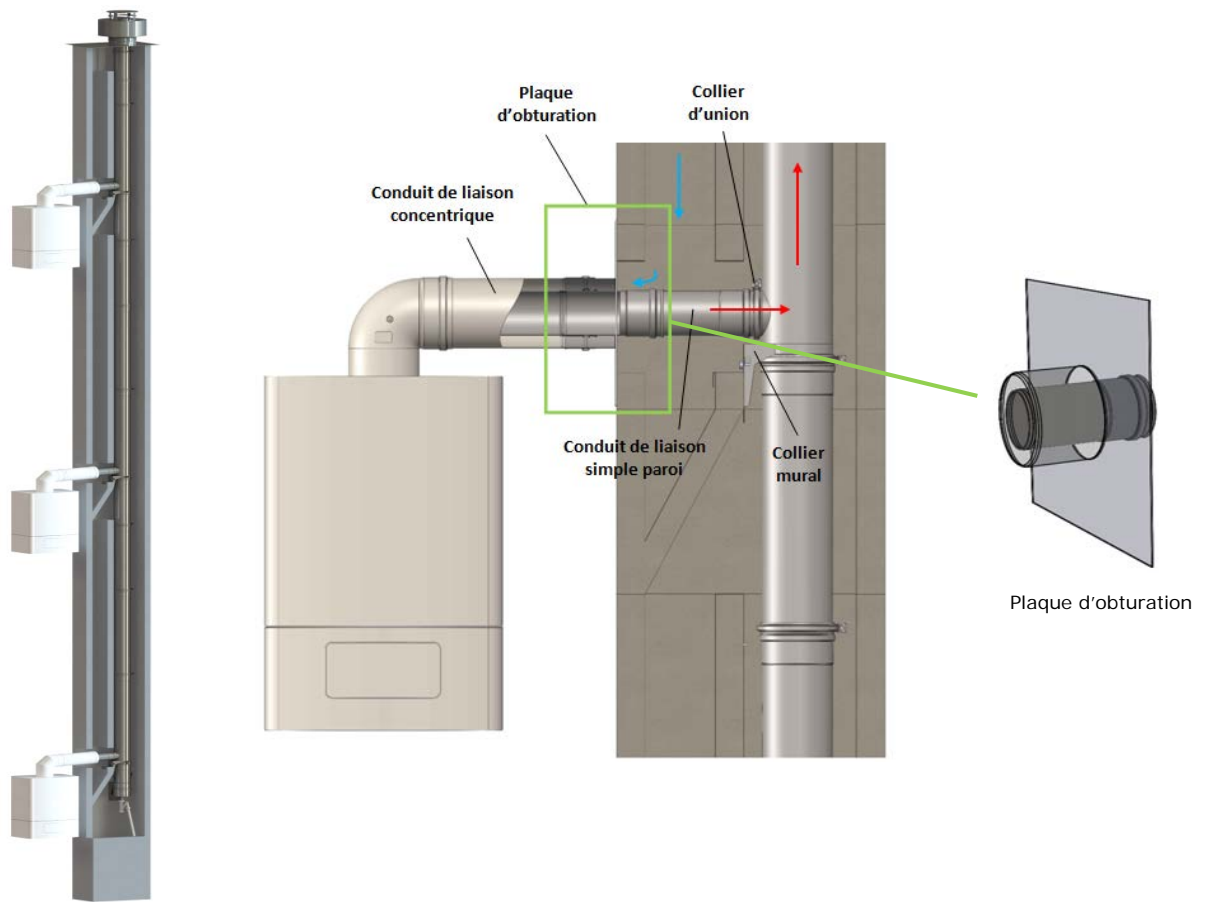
Principe de montage de la version DINAGAS 3CE+ SW à l'intérieur d'un conduit existant
